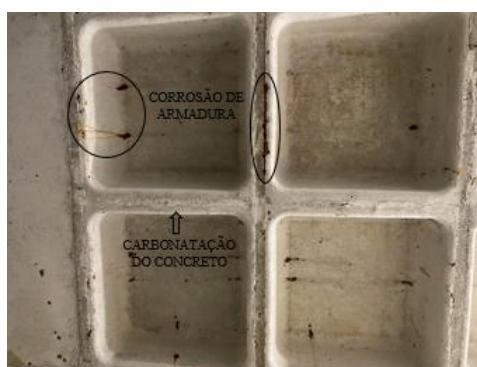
Laje F8 - corrosão de armadura e carbonatação do concreto.
